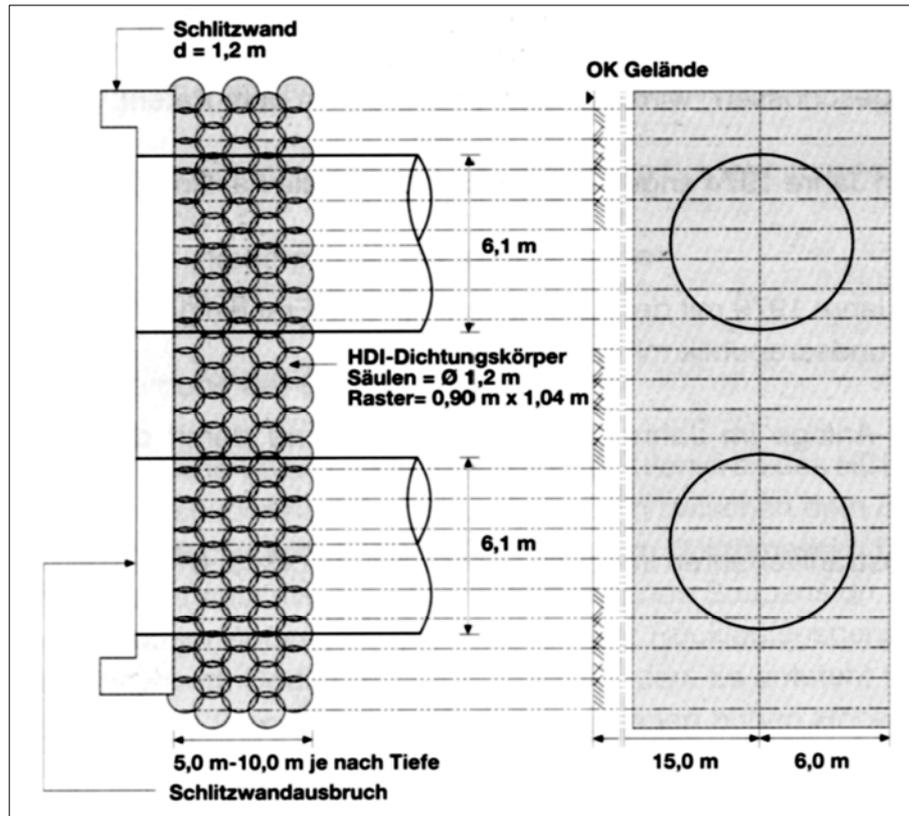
Dichtungsblock für einen Schildvortrieb (Grundriss, Ansicht) [13]
